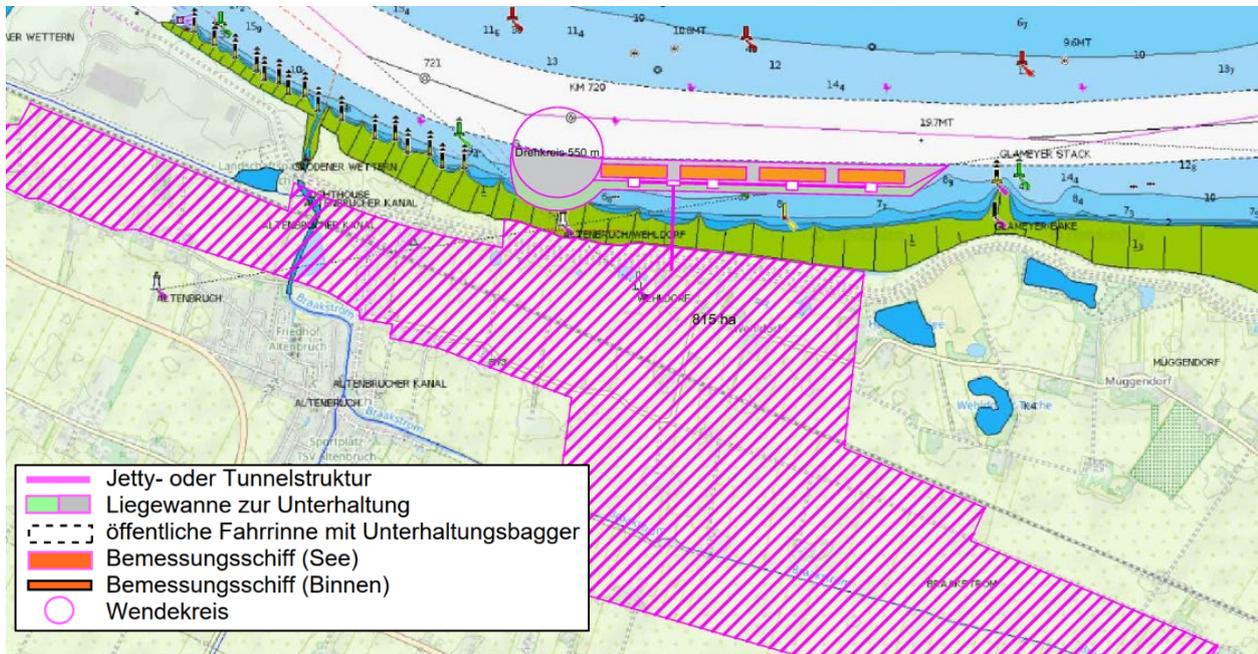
Lageplan Alternative 6: Cuxhaven Altenbruch¹⁸¹
